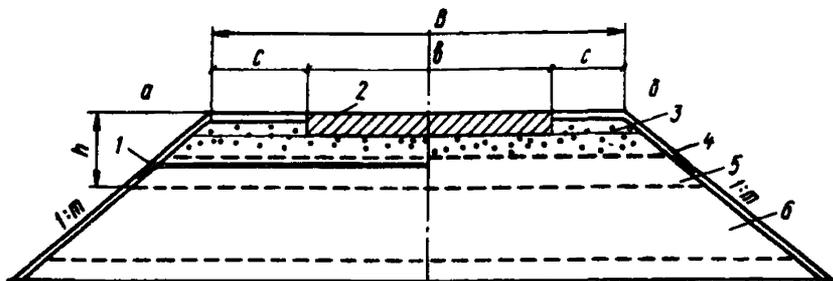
Конструкция насыпи из грунтов повышенной влажности с армирующими прослойками из геотекстиля и геосетки (а), из геосетки (б); 1 - прослойка из геотекстиля; 2 - покрытие; 3 - морозозащитный (дренирующий) слой; 4 - армирующие элементы из геосетки; 5 - рабочий слой из грунта повышенной влажности с $K_y = 0,95$; 6 - тело насыпи из грунта повышенной влажности с $K_y \geq 0,93$
